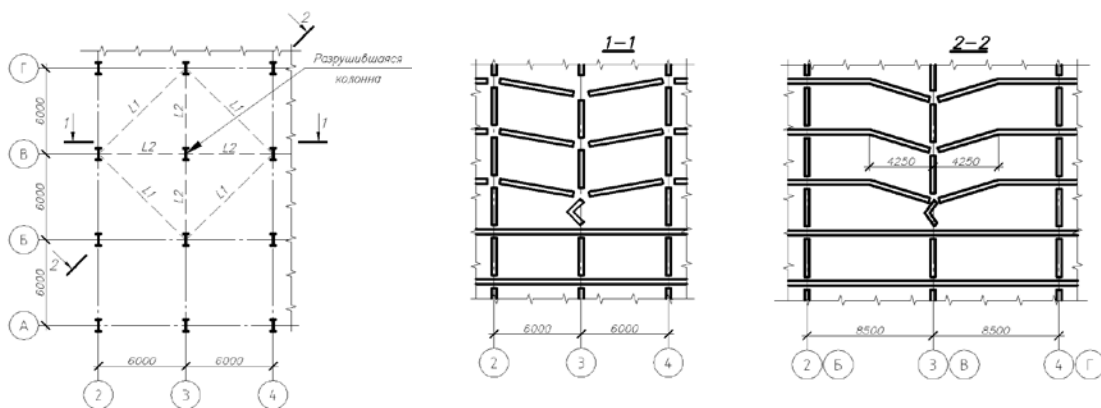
Схема первого механизма обрушения плит перекрытия при разрушении колонны, относящейся к I группе
